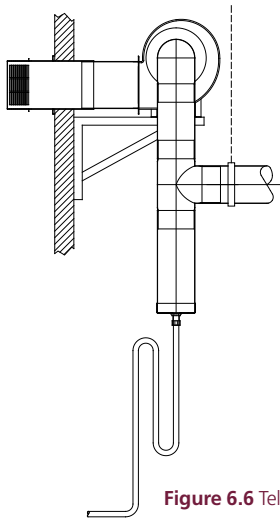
Telescópico de aço inoxidável através da disposição da parede (disponível para ventiladores do tipo 'O' e do tipo '2')
